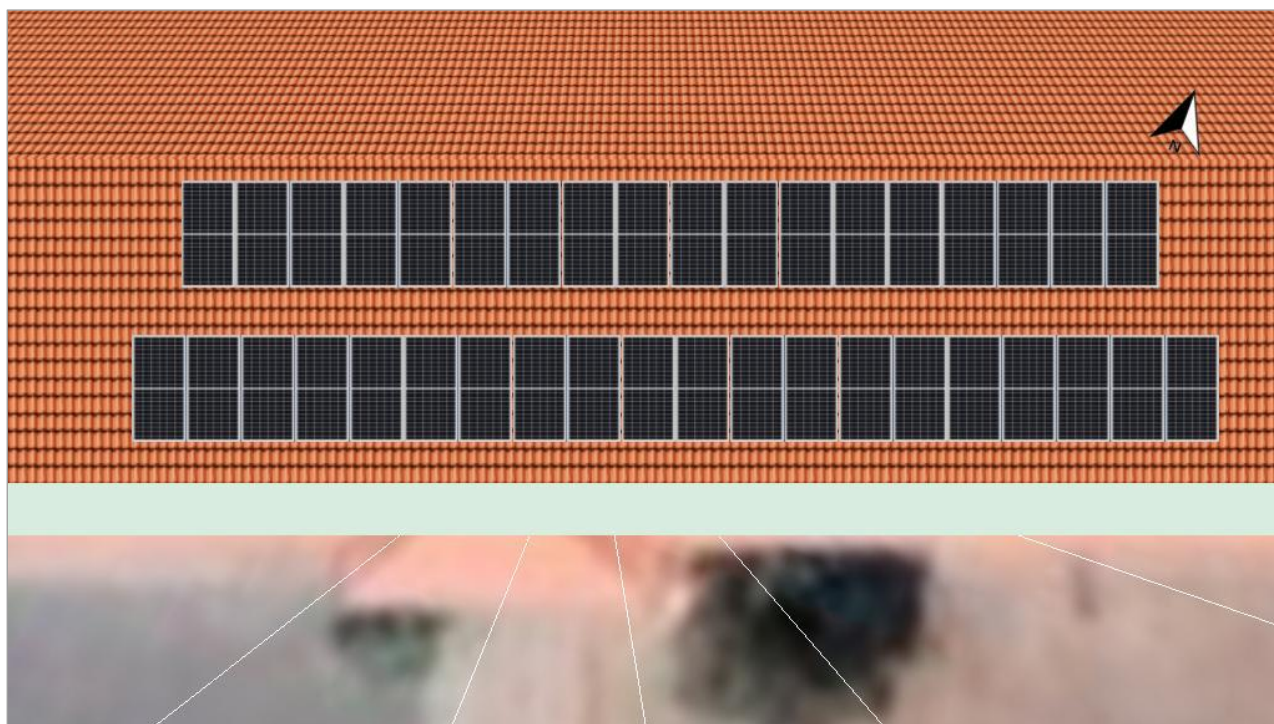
Sipërfaqja e modulit - Building 01-Roof Area South
